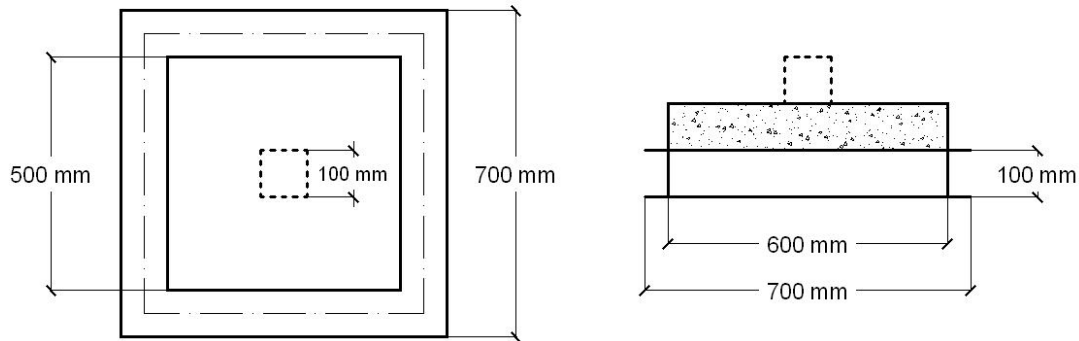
Esquema montaje ensayo placa cuadrada (EFNARC)
